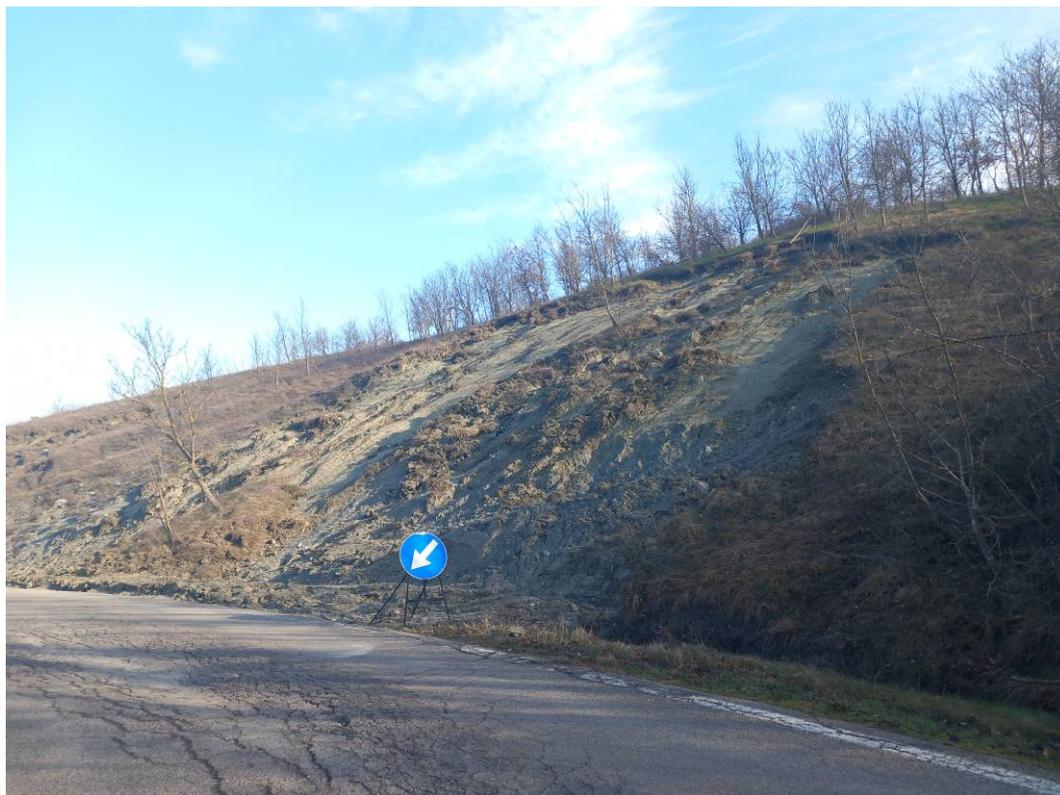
Vista del versante franato nel tratto stradale lato Canossa, a marzo 2025
